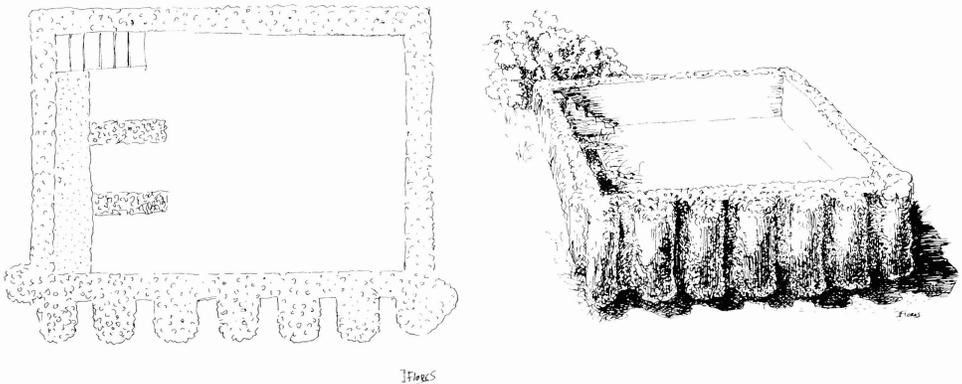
Planta y alzado de los contrafuertes de la cisterna del Cerro del Cobre, ya derruida.
